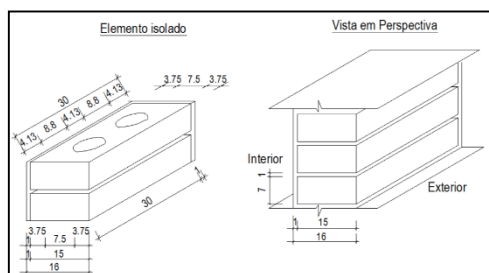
Perspectiva do elemento isolado e da parede de BTC.
